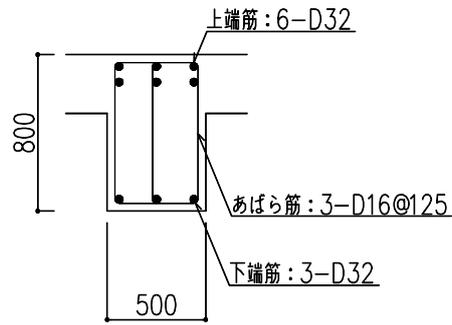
大ばりの配筋図（地下1階，YC 通り X33～X34 通り間，端部）（単位：mm）
